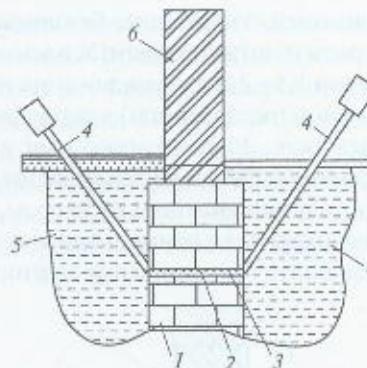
Устранение разрыва ленточного фундамента цементным раствором:
